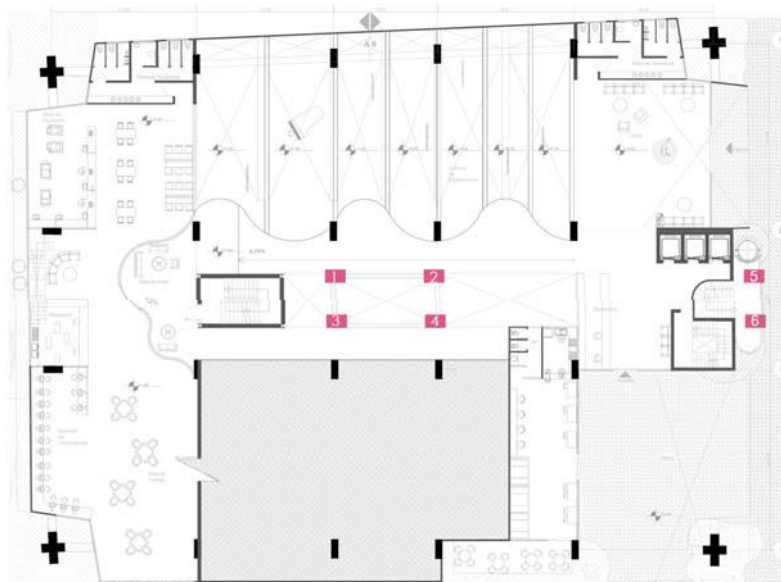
Planta Baja columnas de acero. Elaboración propia.
